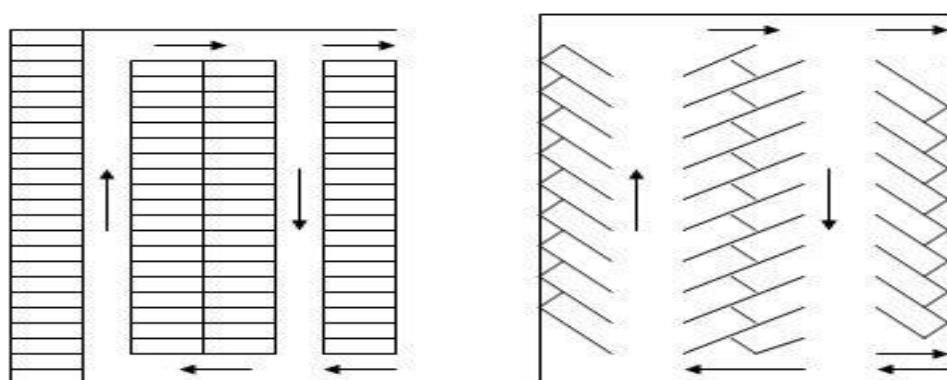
Parkir Sudut yang Saling Berhadapan
